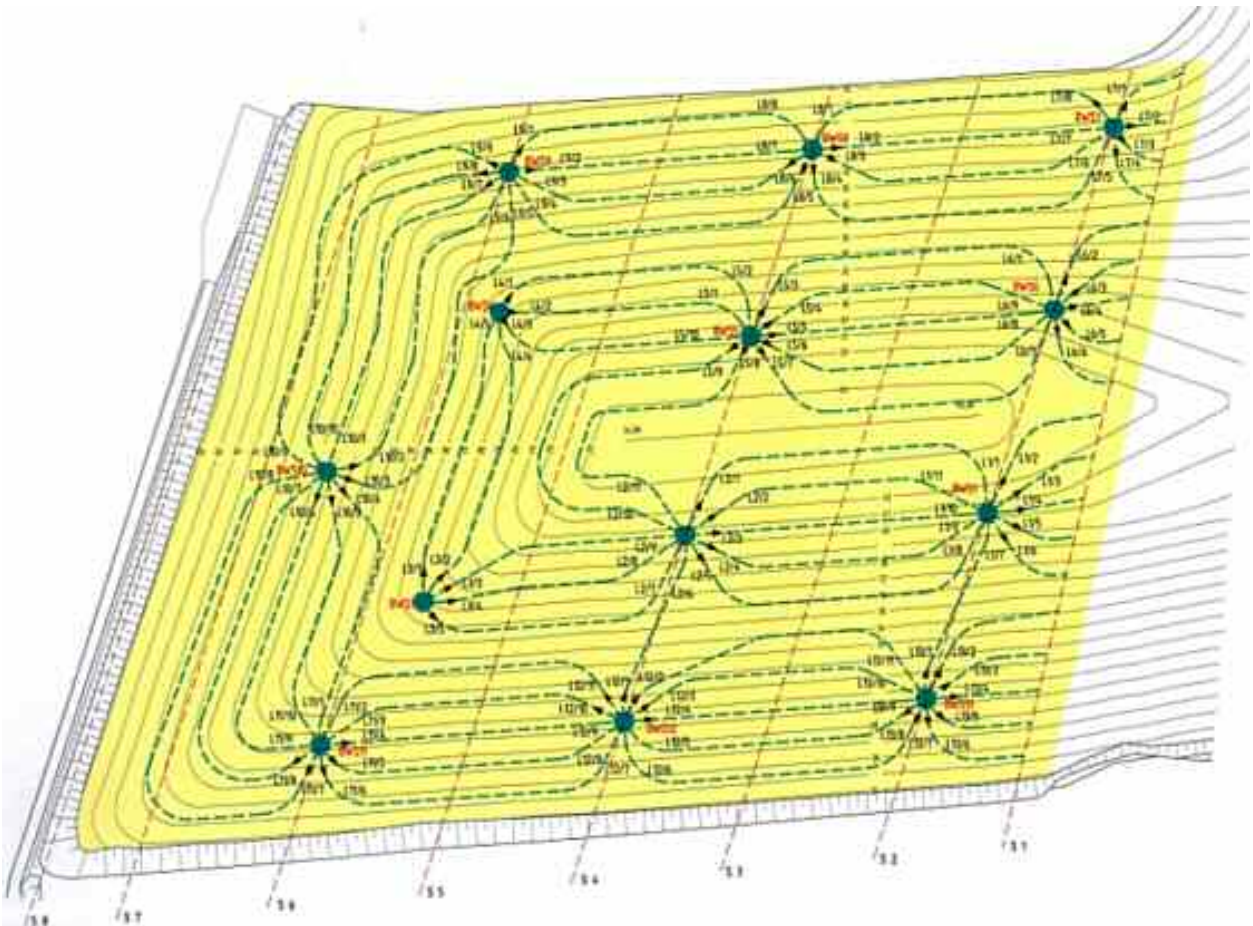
Lageplan Bauabschnitte II und III mit Bewässerungssystem
